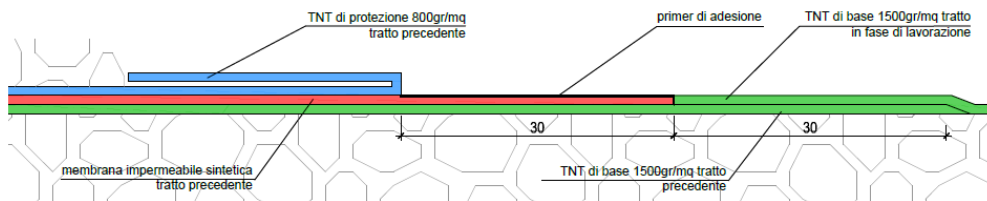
b - Ripresa dell'impermeabilizzazione (in rosso)
